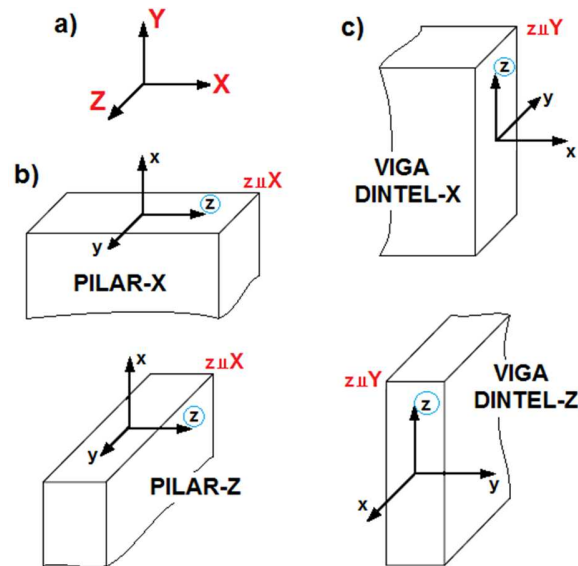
Sistemas de coordenadas adoptados: a) global; b) coordenadas locales para pilares; c) coordenadas locales para vigas-dintel
